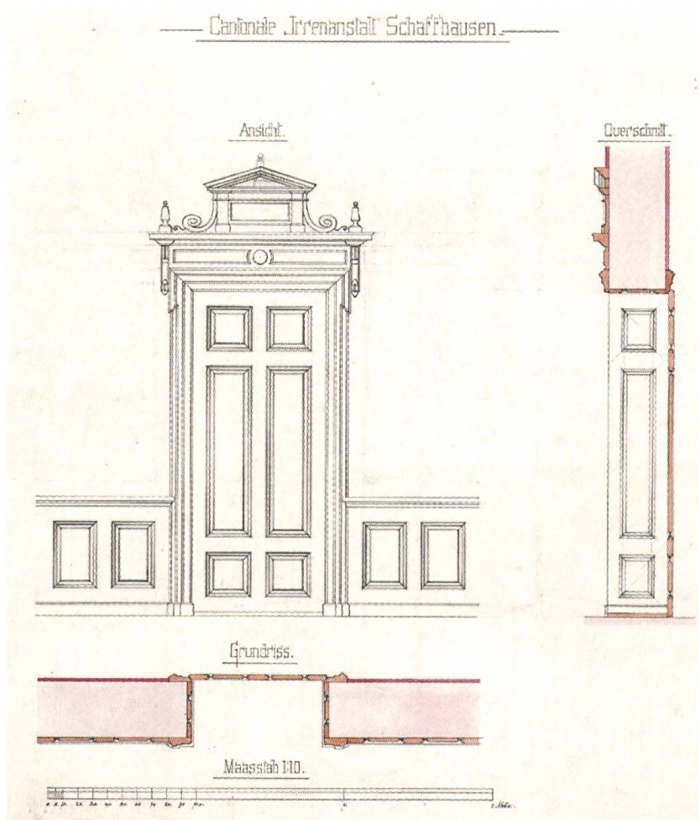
Ansicht, Grundriss und Querschnitt einer Zimmertür in der Klinik Breitenau, vermutlich im Verwaltungstrakt, Johann Christoph Bahnmaier (?), ca. 1888–1891. Aquarellierte Zeichnung, 60 × 69 cm, Massstab 1 : 10. STASH SSH948-176.
